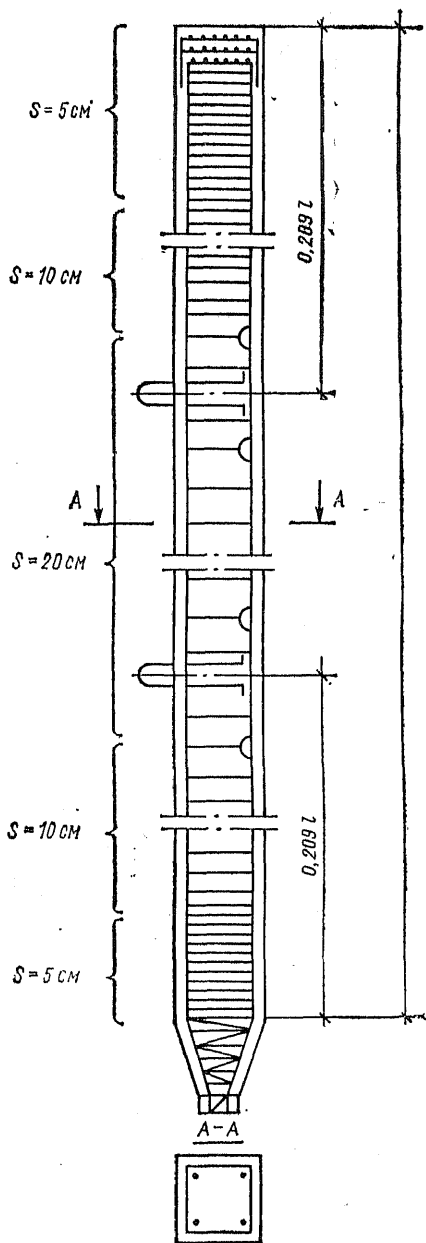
Конструкция железобетонной сваи (s — шаг спиральной поперечной арматуры)
